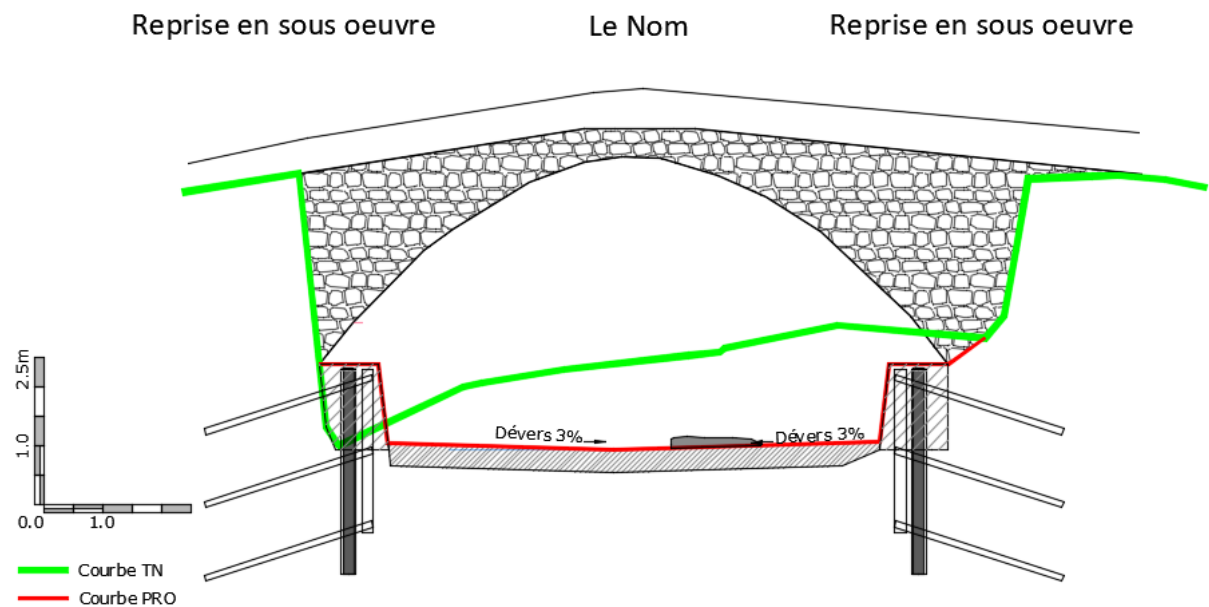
Coupe type des protections de berges du secteur future passerelle-Vieux Pont
